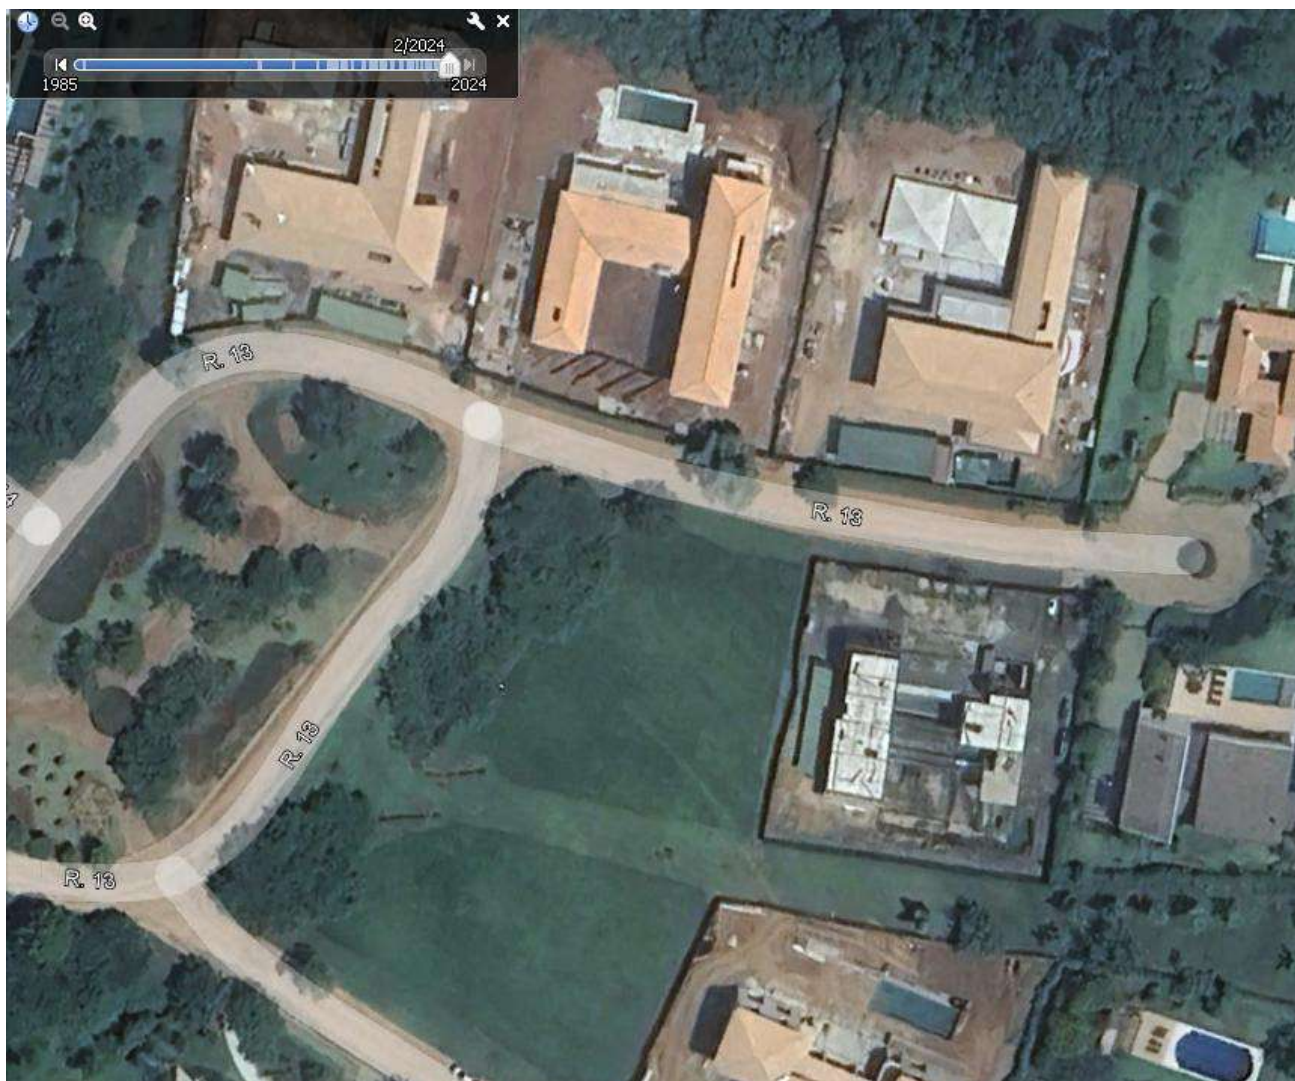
Foto aérea mais recente disponível da construção (fevereiro de 2024)
